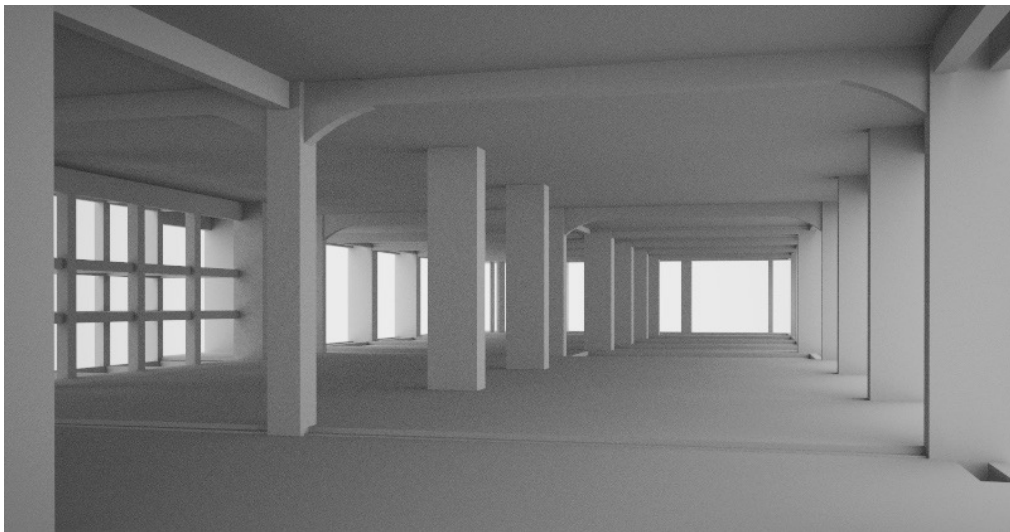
e 262 – 18º pavimento acima e 19º pavimento abaixo. Uso de vigas vierendeel para o recurso de vão livre de pilares. Modelo realizado pelo autor. FONTE: SEEBLA, 2014 e PAMPONET, 2015.
